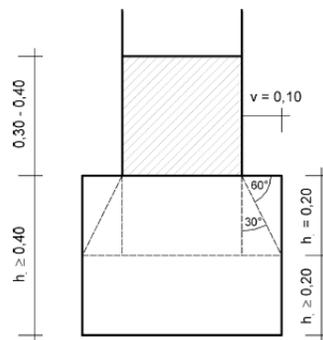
Cimentación y sobrecimentación. Fuente: Minke (2001).
